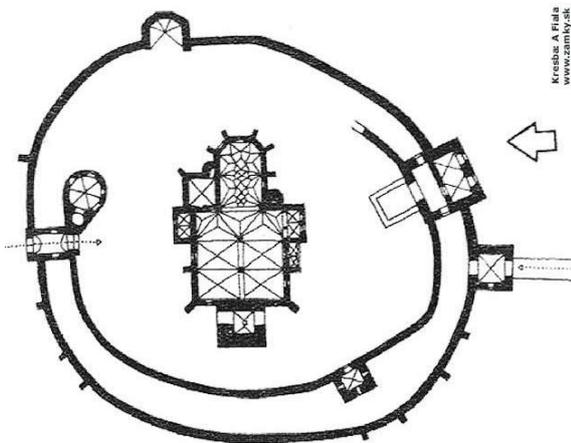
Kremnica, Stadtburg, Grundriss, 13. und 15. Jahrhundert
